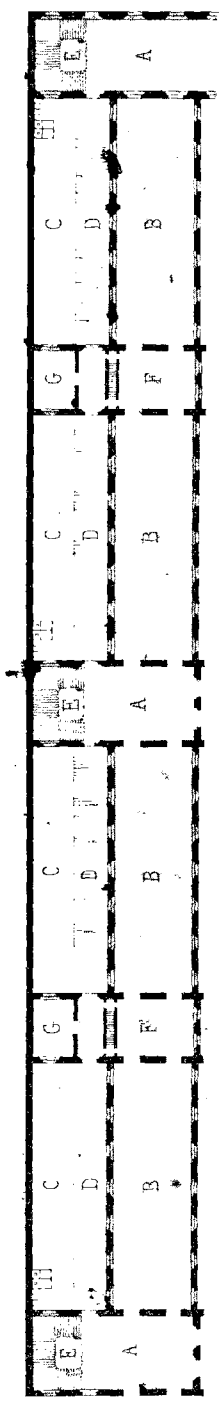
PLAN D'UN LABORATOIRE DE 1^{RE} ANNÉE (REZ-DE-CHAUSSÉE)
